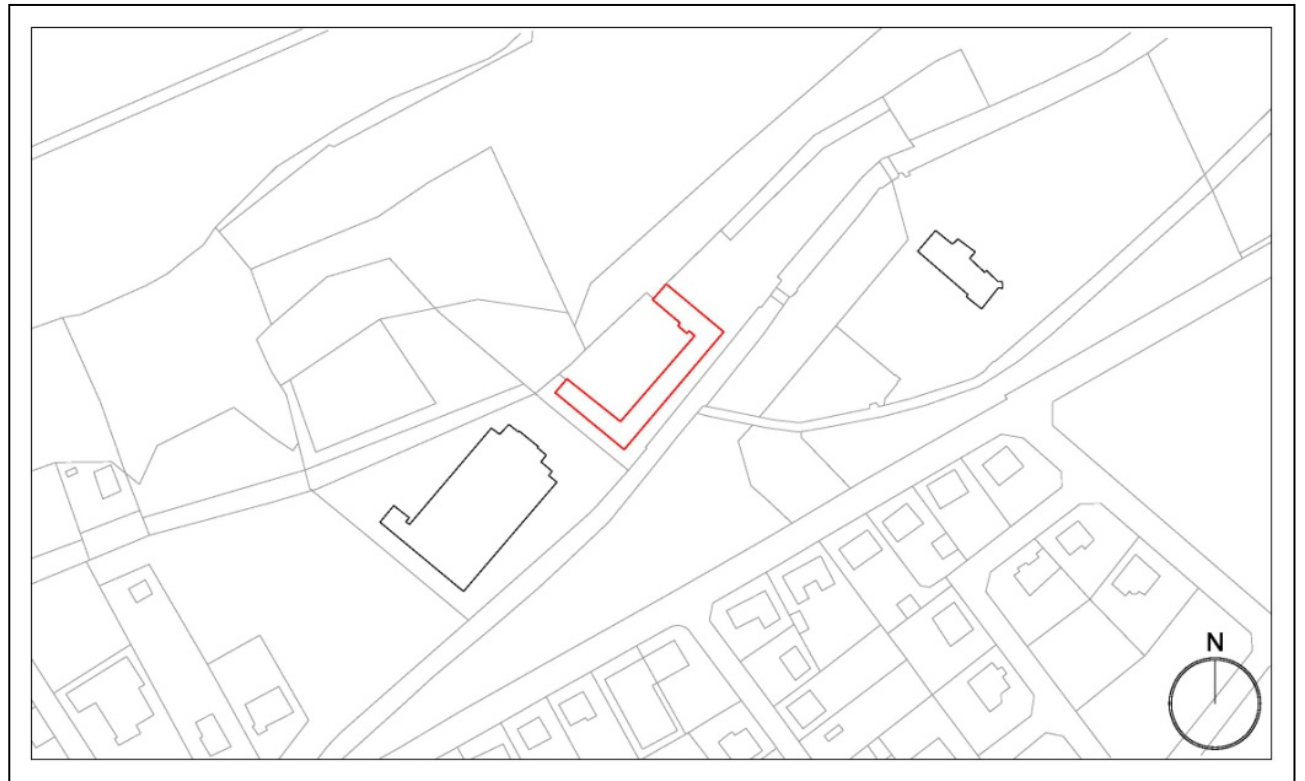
Lageplan, Bestand Arbeiterwohnhaus
